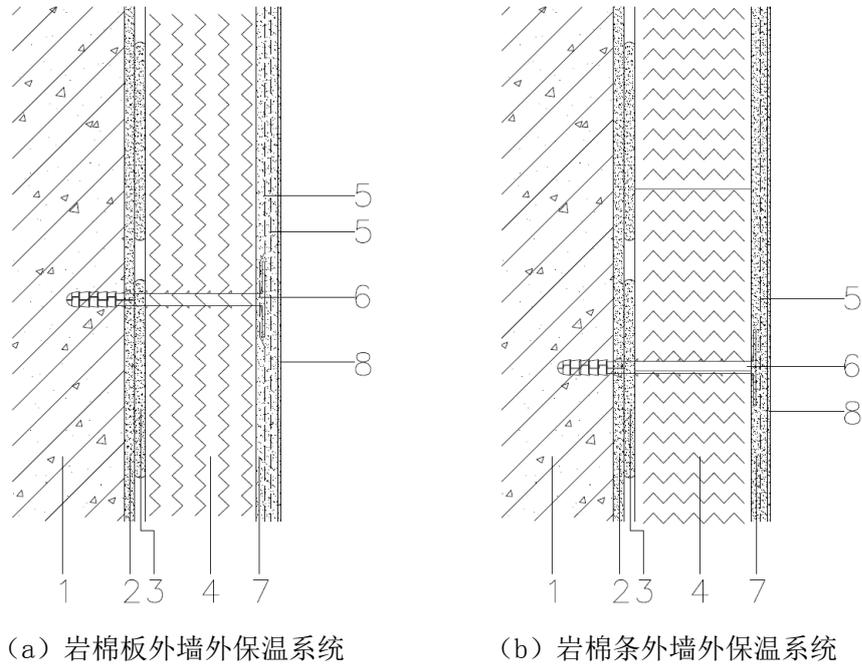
岩棉板外墙外保温系统构造示意图
